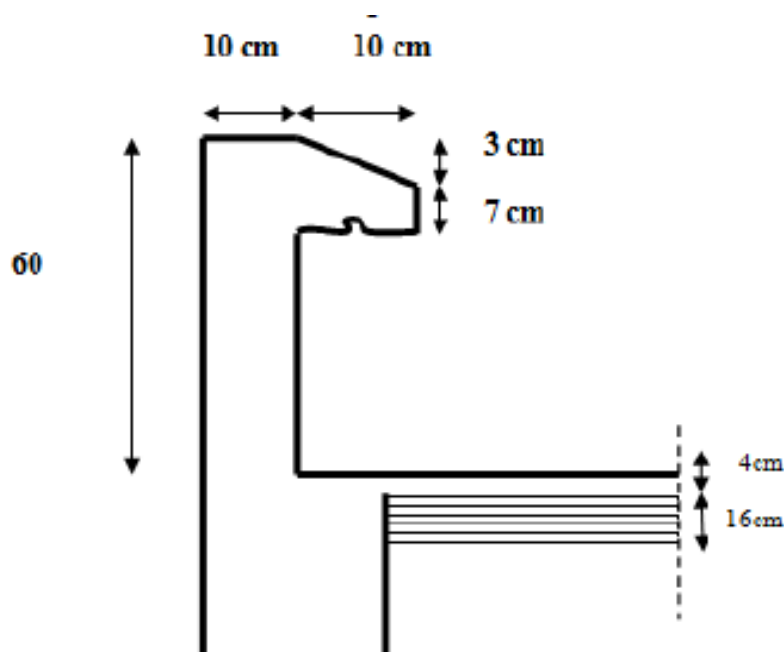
Coupe transversale de l'acrotère. [22]
